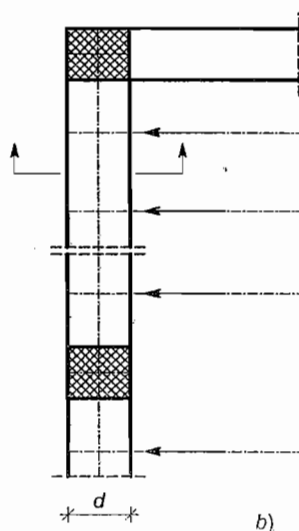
Armiranobetonska nastrešna stijena kruto vezana sa stropnom konstrukcijom:
